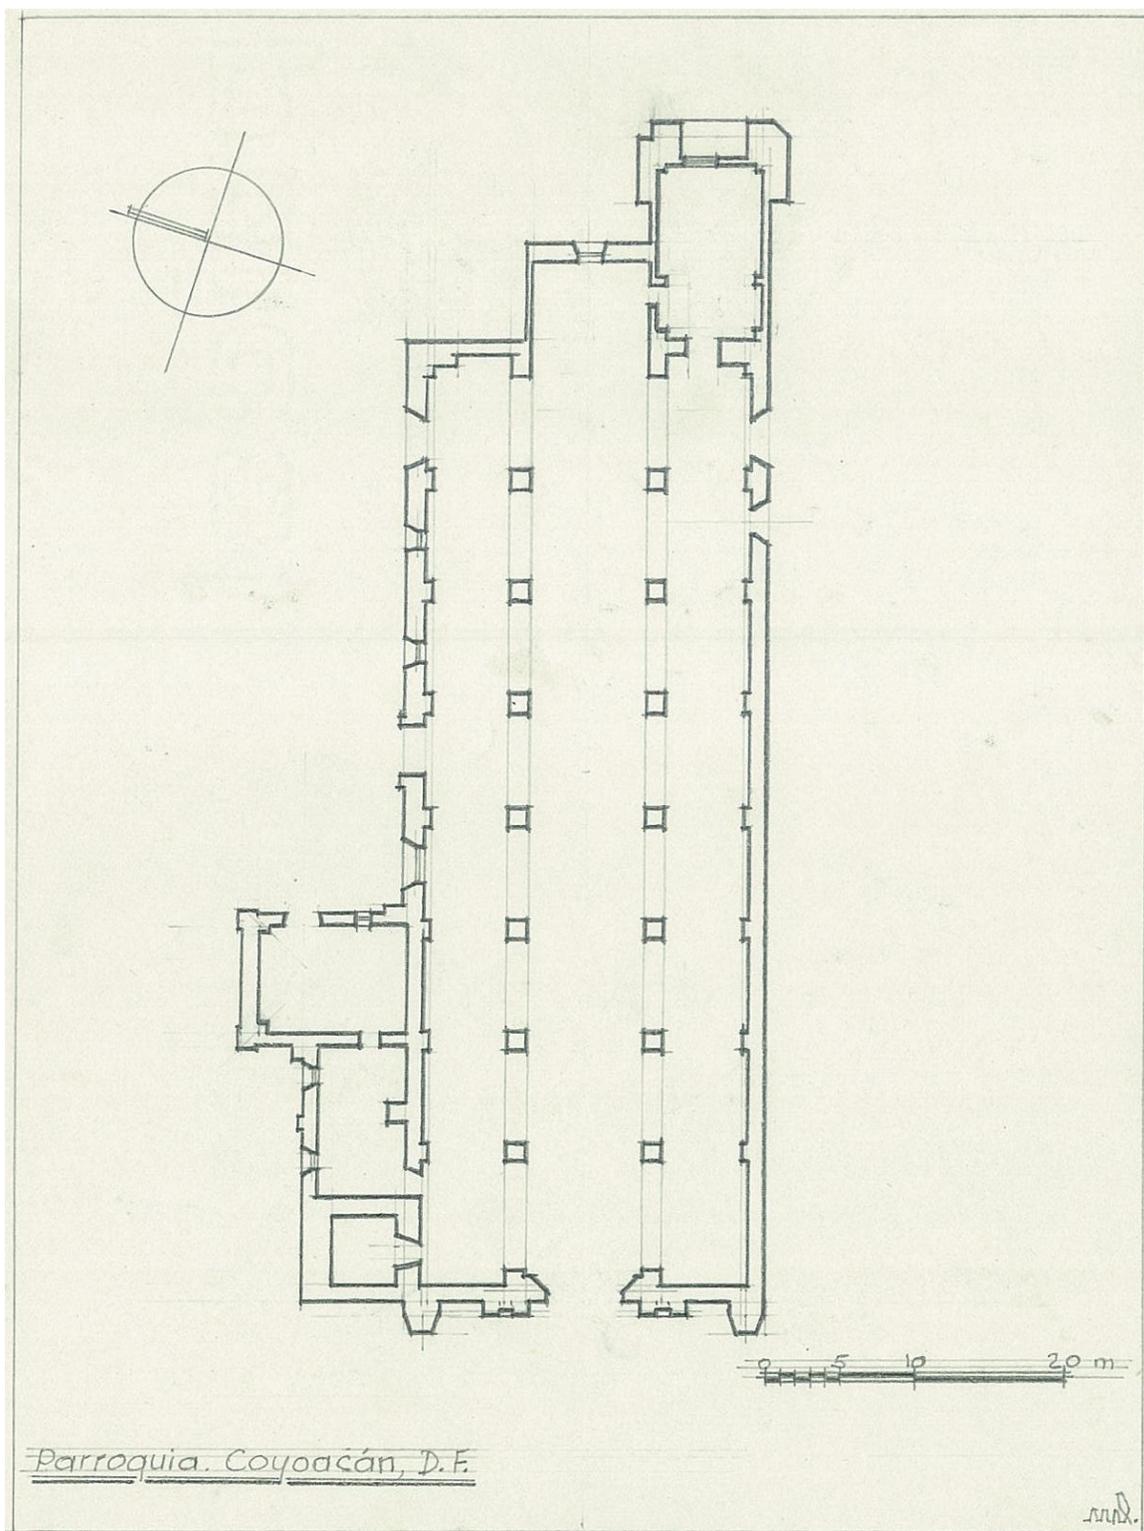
Parroquia de San Juan Bautista, Coyoacán, D. F. Planta (Dibujo del autor, reconstitución del estado original, a partir del plano No. 5365 y del No. 5366)
